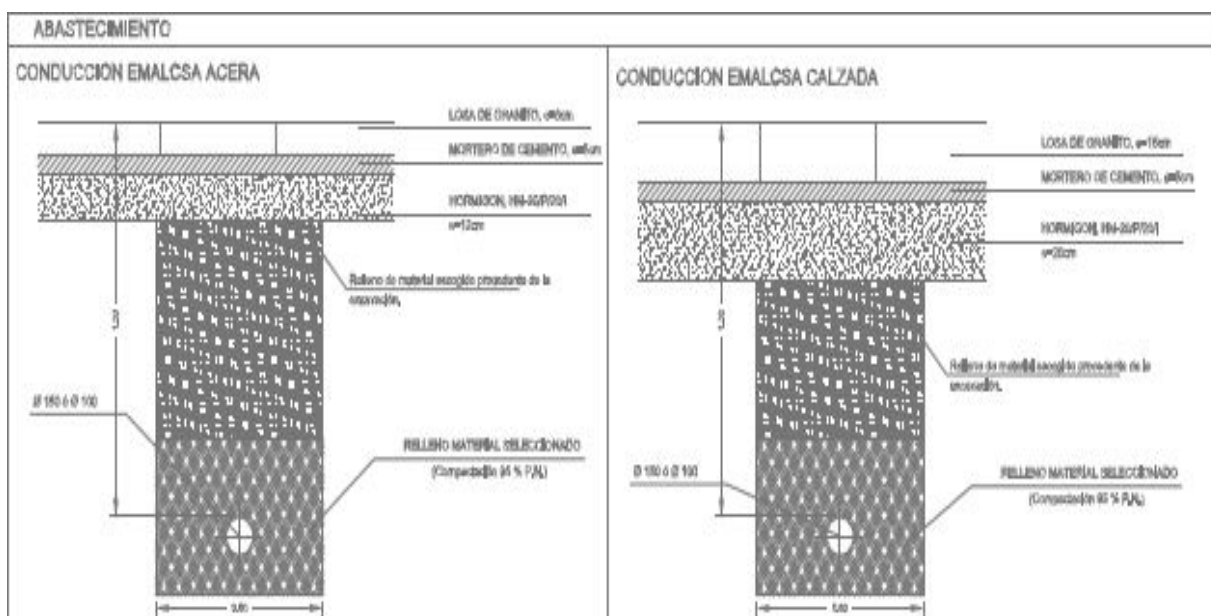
Planos de detalle de las instalaciones de zanjas.
